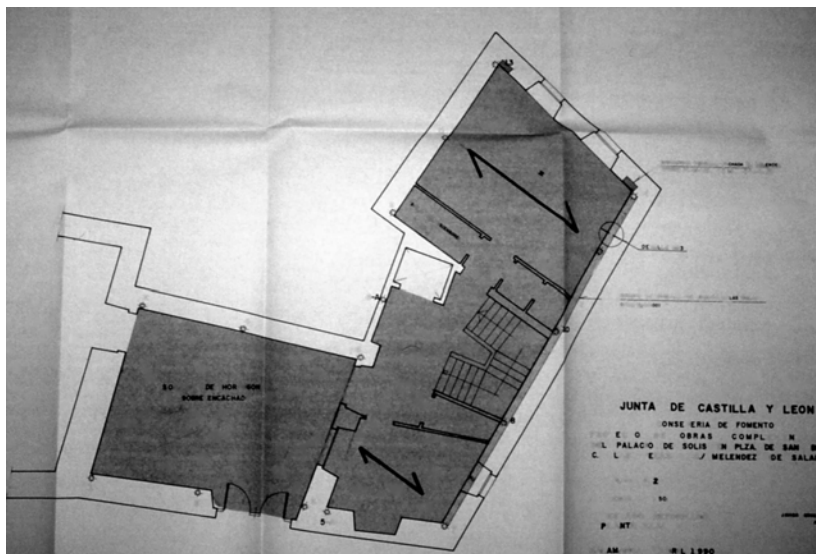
Casa de los Solís: planta baja, por J. Gómez Riesco, 1987.
